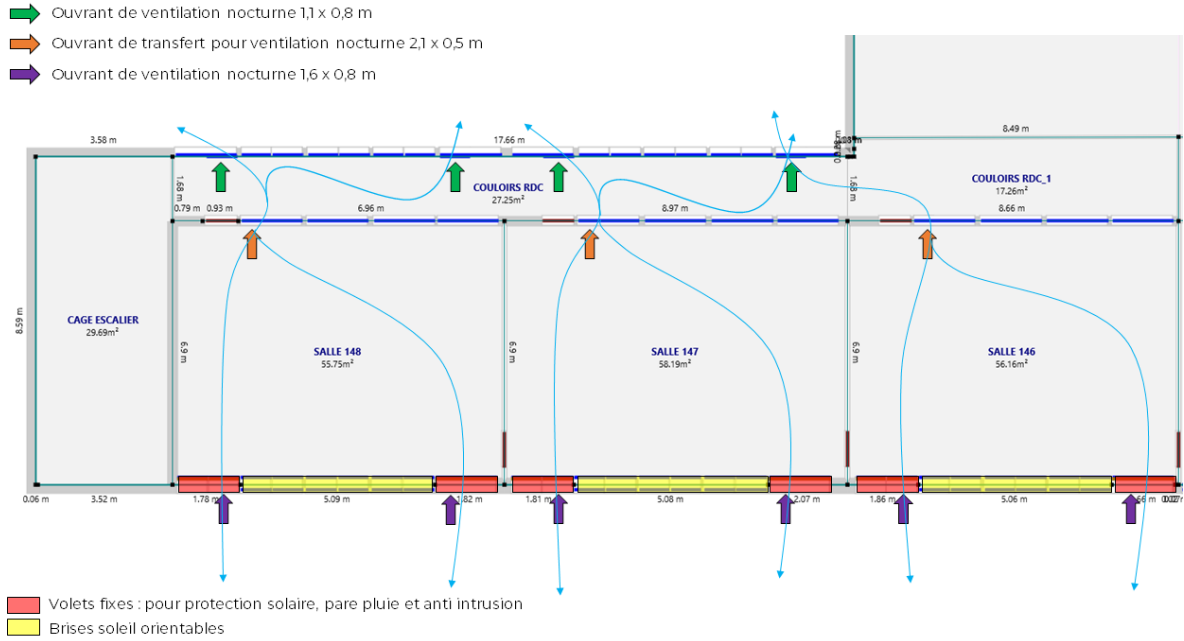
plan de repérage protections solaires extérieures et surventilation nocturne du RDC
